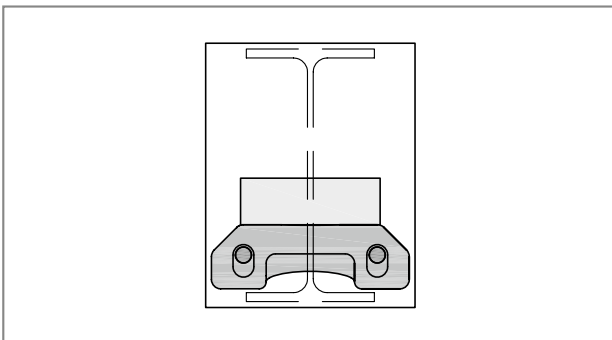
Schöck Isokorb® T type SQ: verdraaide en verschoven elementen door onvoldoende fixatie tijdens het beton storten
